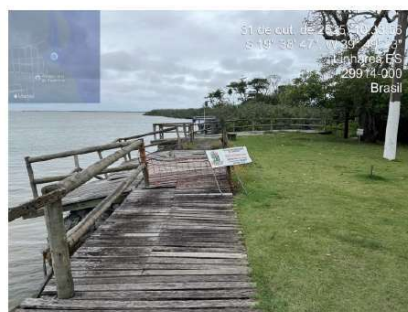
Estrutura existente do deck de madeira e do corrimão
